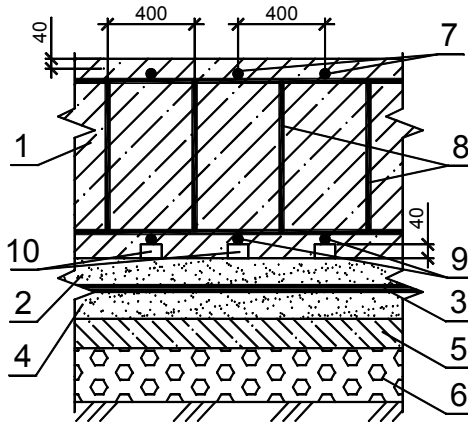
Конструкция классической монолитной железобетонной фундаментной плиты:
